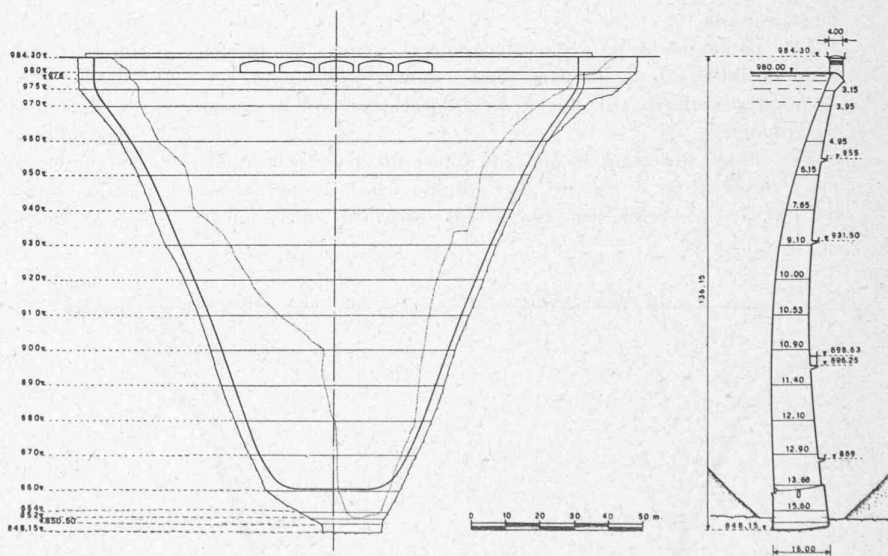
Barrage du Lumiei. — Elévation et coupe médiane.
